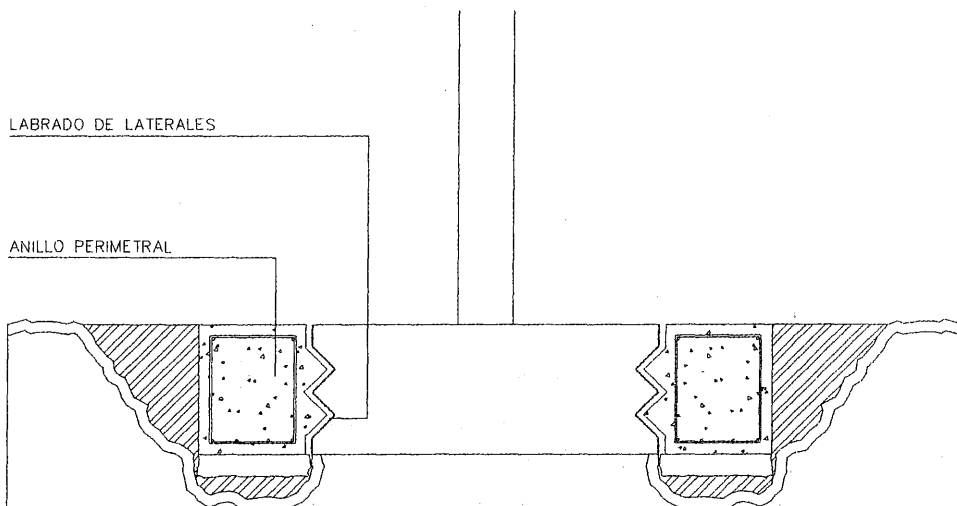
Recalce superficial de zapata aislada aumentando su superficie de apoyo mediante un anillo perimetral de hormigón armado con dentados laterales.
